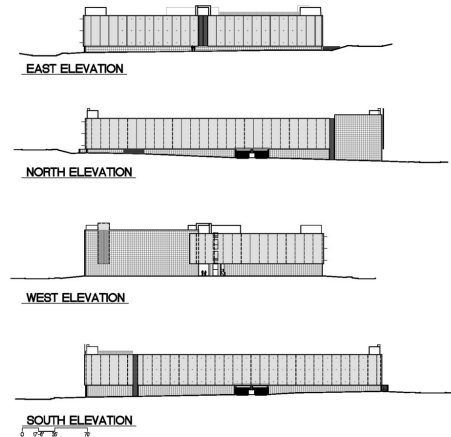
Fachadas arquitectónicas edificio Chesapeake car park
